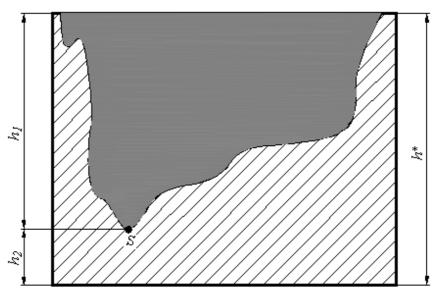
Одна з можливих форм корозійного дефекту по глибині стінки труби
